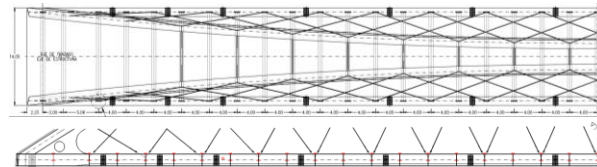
Planta y elevación longitudinal con la definición de vigas longitudinales y transversales.
